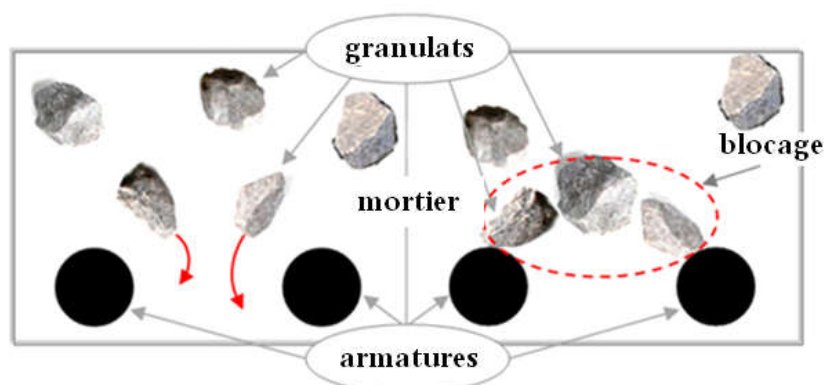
représentation en plan d'un blocage de granulats à travers deux armatures
